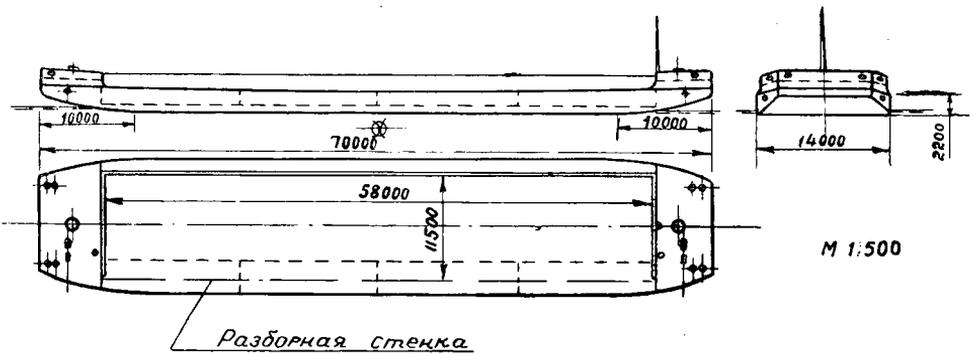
Общий вид открытой палубной металлической баржи с крен-балластными цистернами.
